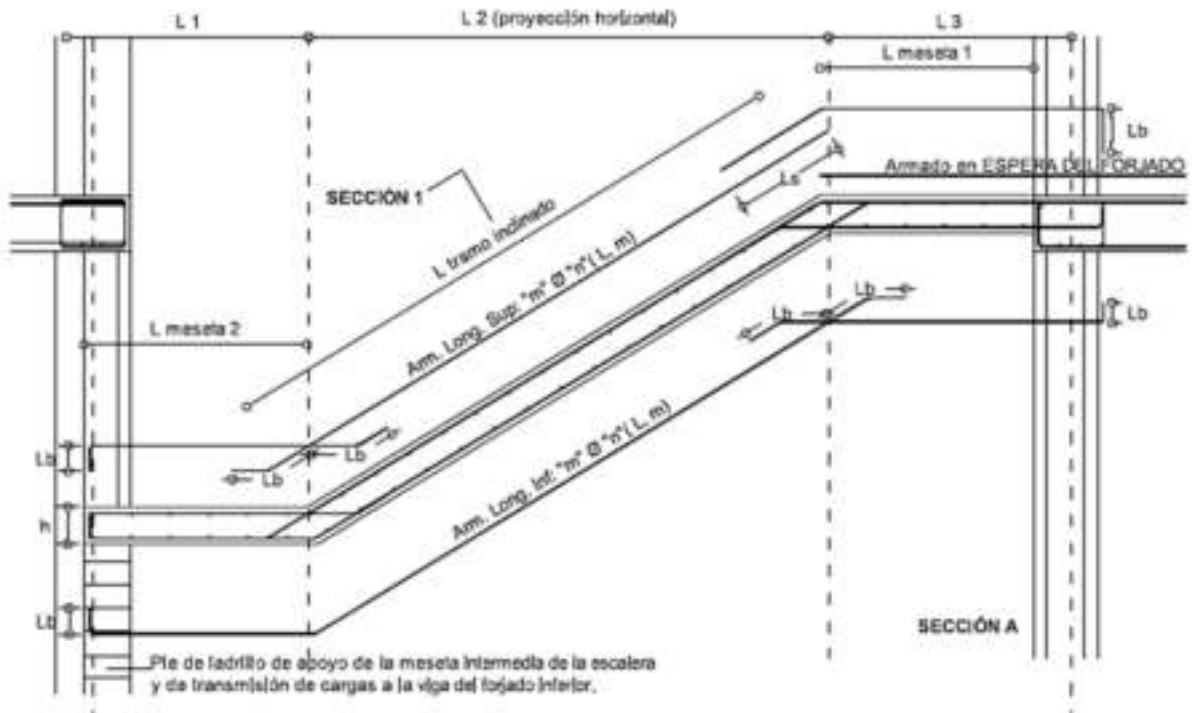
Detalle de la armadura de una escalera típica tramo I
